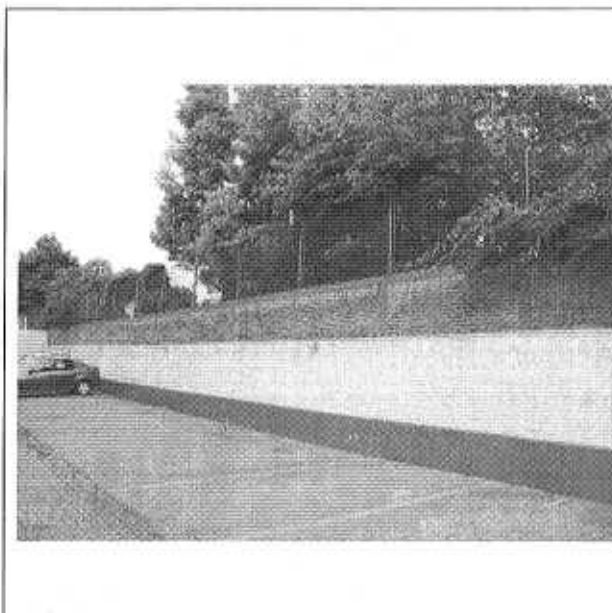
Muro de cerramiento del Conjunto Residencial Los Pinos, Calle 89 No. 85A-33.
